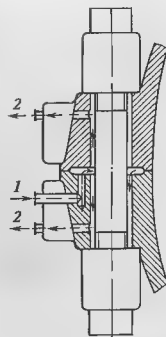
Схема обогрева фланцевых соединений, скрепленных болтами
